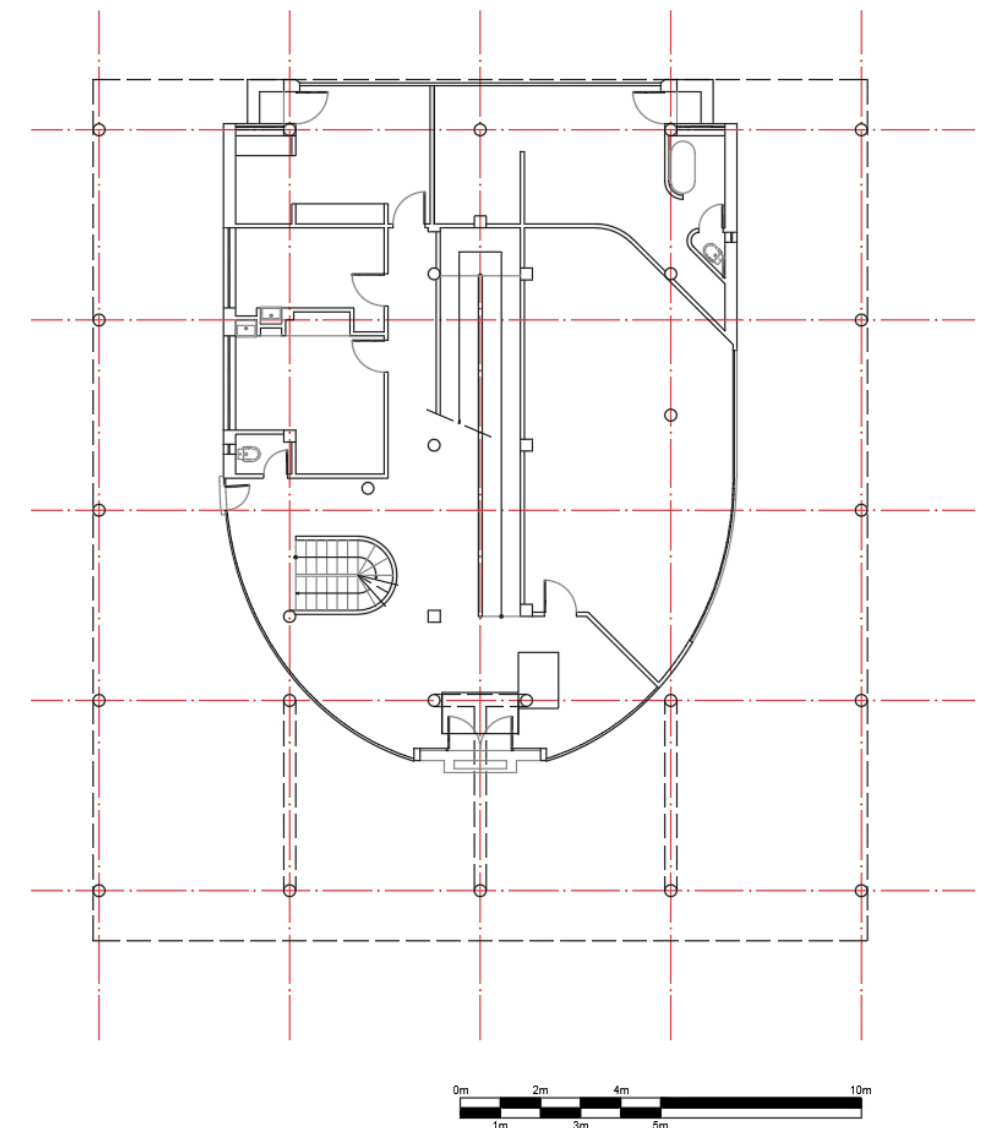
Moduli della Villa Savoye, Pianta Bassa Piano Terra.
